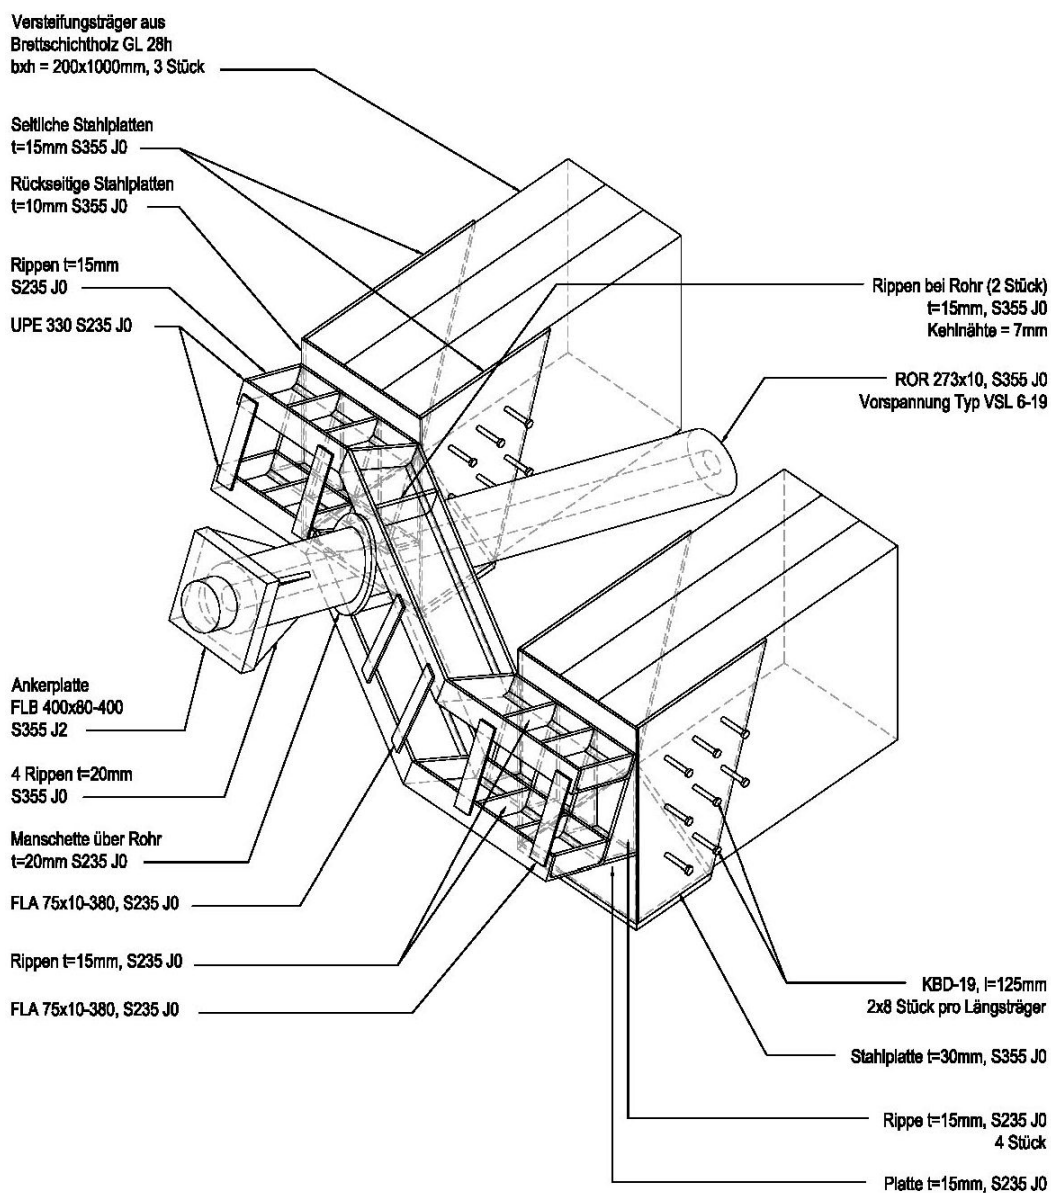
Typ. Anschlussdetail: Anschlüsse bei End-Querträger
